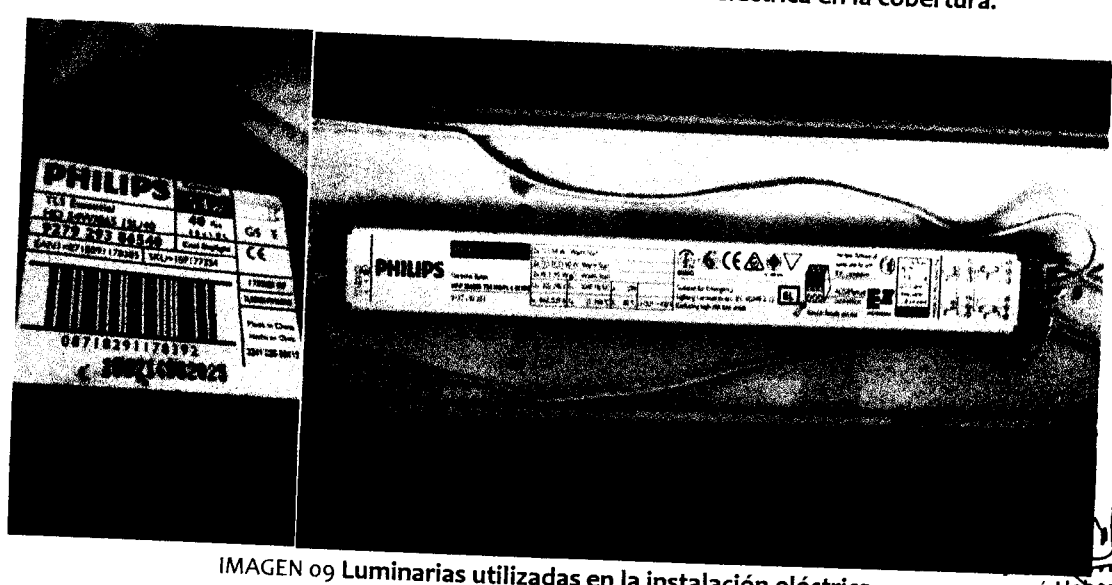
Luminarias utilizadas en la instalación eléctrica.
